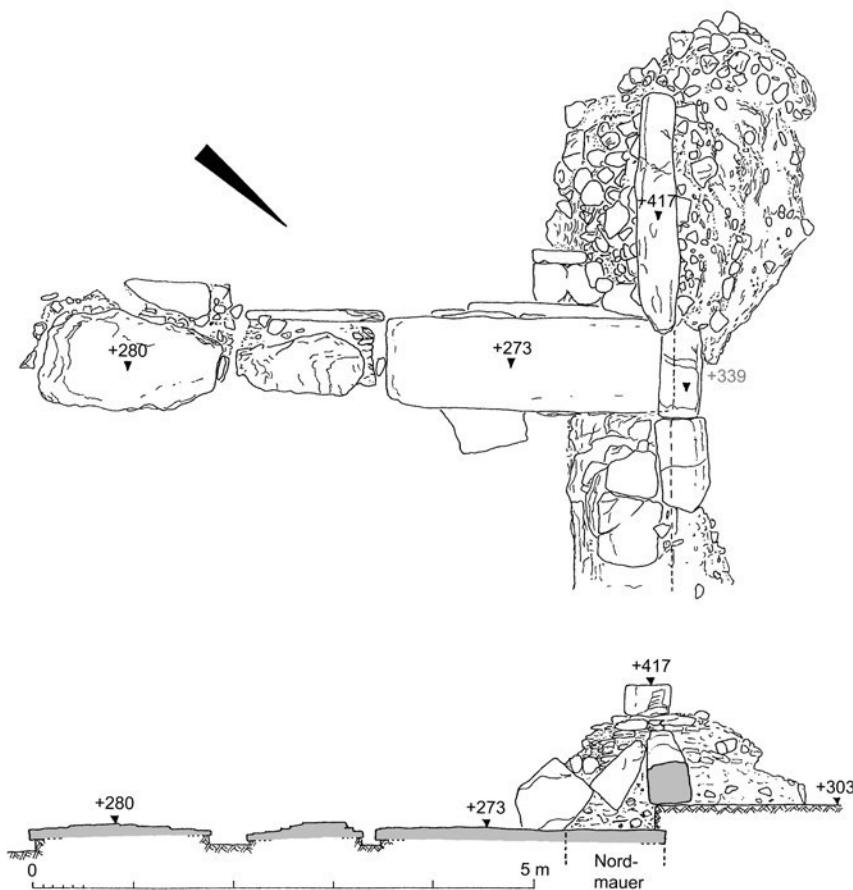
Grundriss und Schnitt der Nordwestecke der ›Nordwesthalle‹ mit späterer Umpackung (M. 1 : 75)
